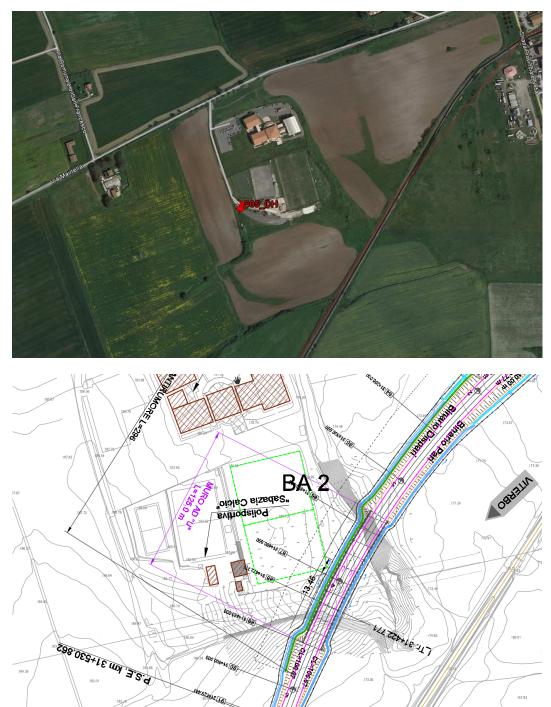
Muro ad U: inquadramento planimetrico, posizione polisportiva e sondaggio limitrofo
